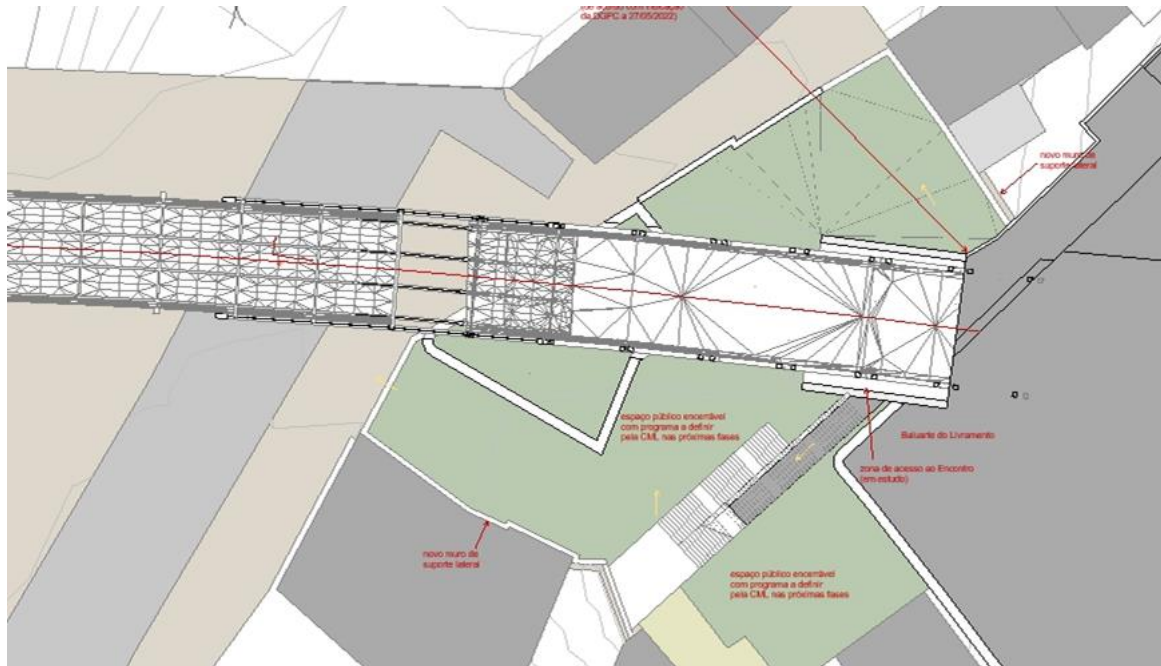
Planta piso térreo zona envolvente ao Baluarte (ML 134362).
